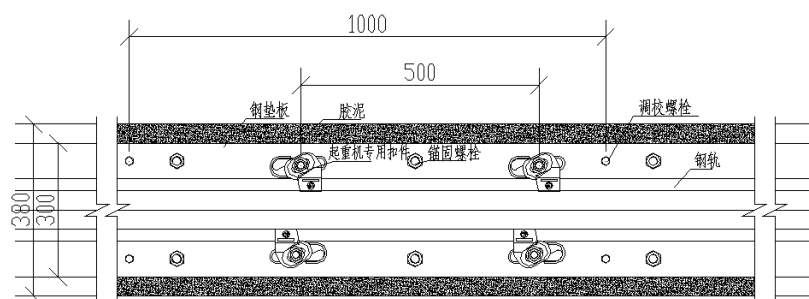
龙门吊走行轨扣件平面布置图 单位：mm
